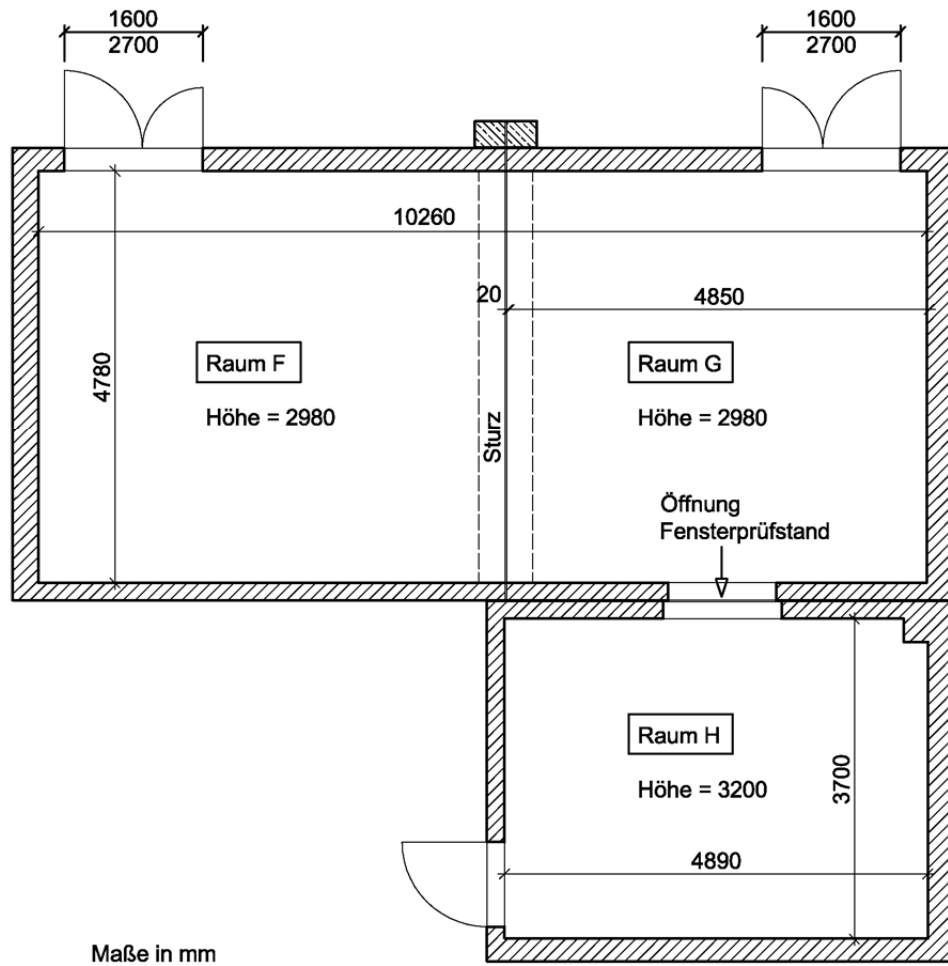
Grundriss des Fensterprüfstands.
